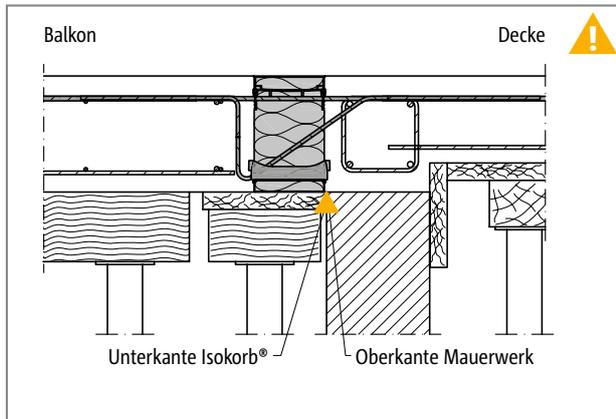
Schöck Isokorb® Typ KXT: Ortbetonbalkon mit höhenversetzter Decke auf Mauerwerkswand
